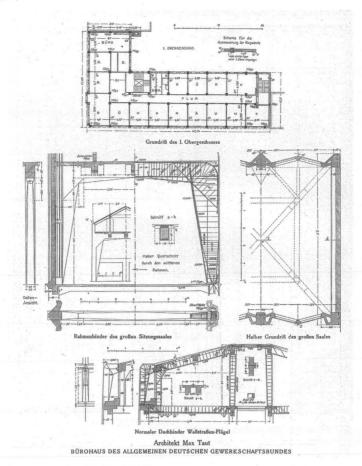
Edificio de Max Taut. Estructura, cimentación y detalles constructivos (AHCOAM GM/CP088/C1-39)
